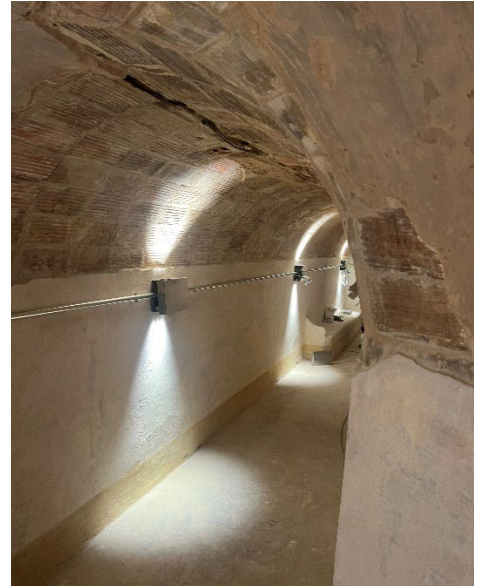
Imagen de la galería tras la restauración. (Marina Sender Contell, 2023).
